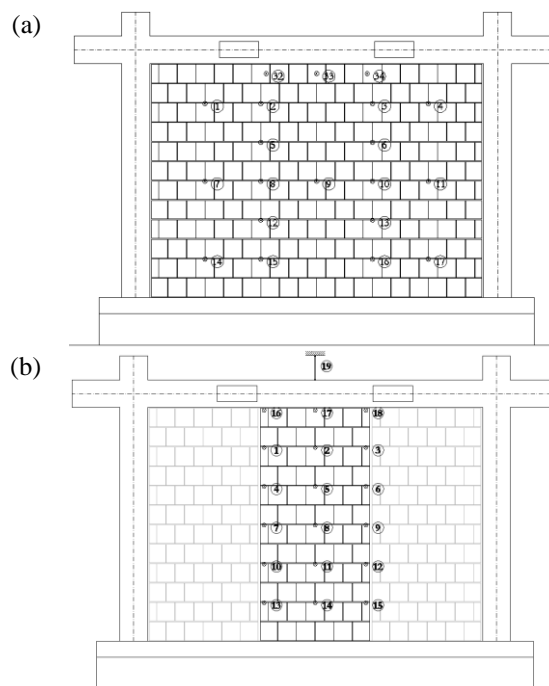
Layout della strumentazione adottata per: (a) i tamponamenti pieni TA1, TA2 e TA3; (b) la striscia muraria TA5.
